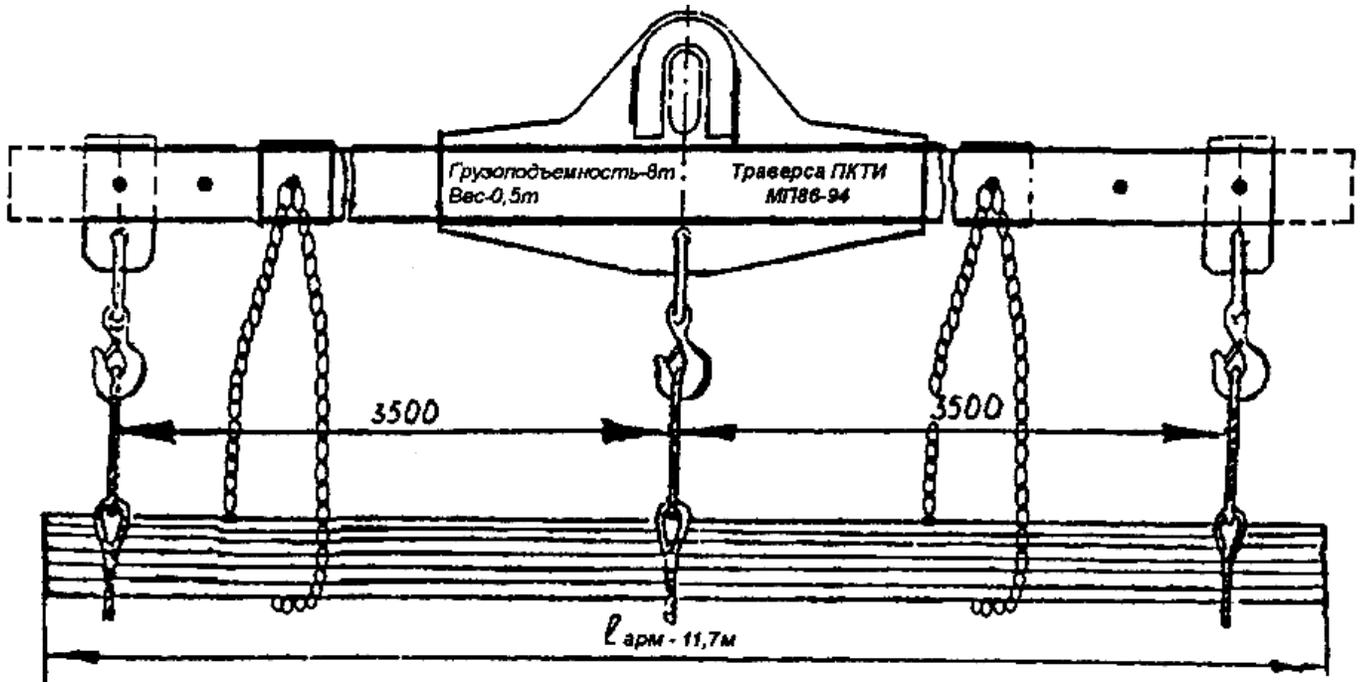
Траверса универсальная для подъема и перемещения пакета арматуры (канатная). Грузоподъемность 8т. Вес 0,5 т.
